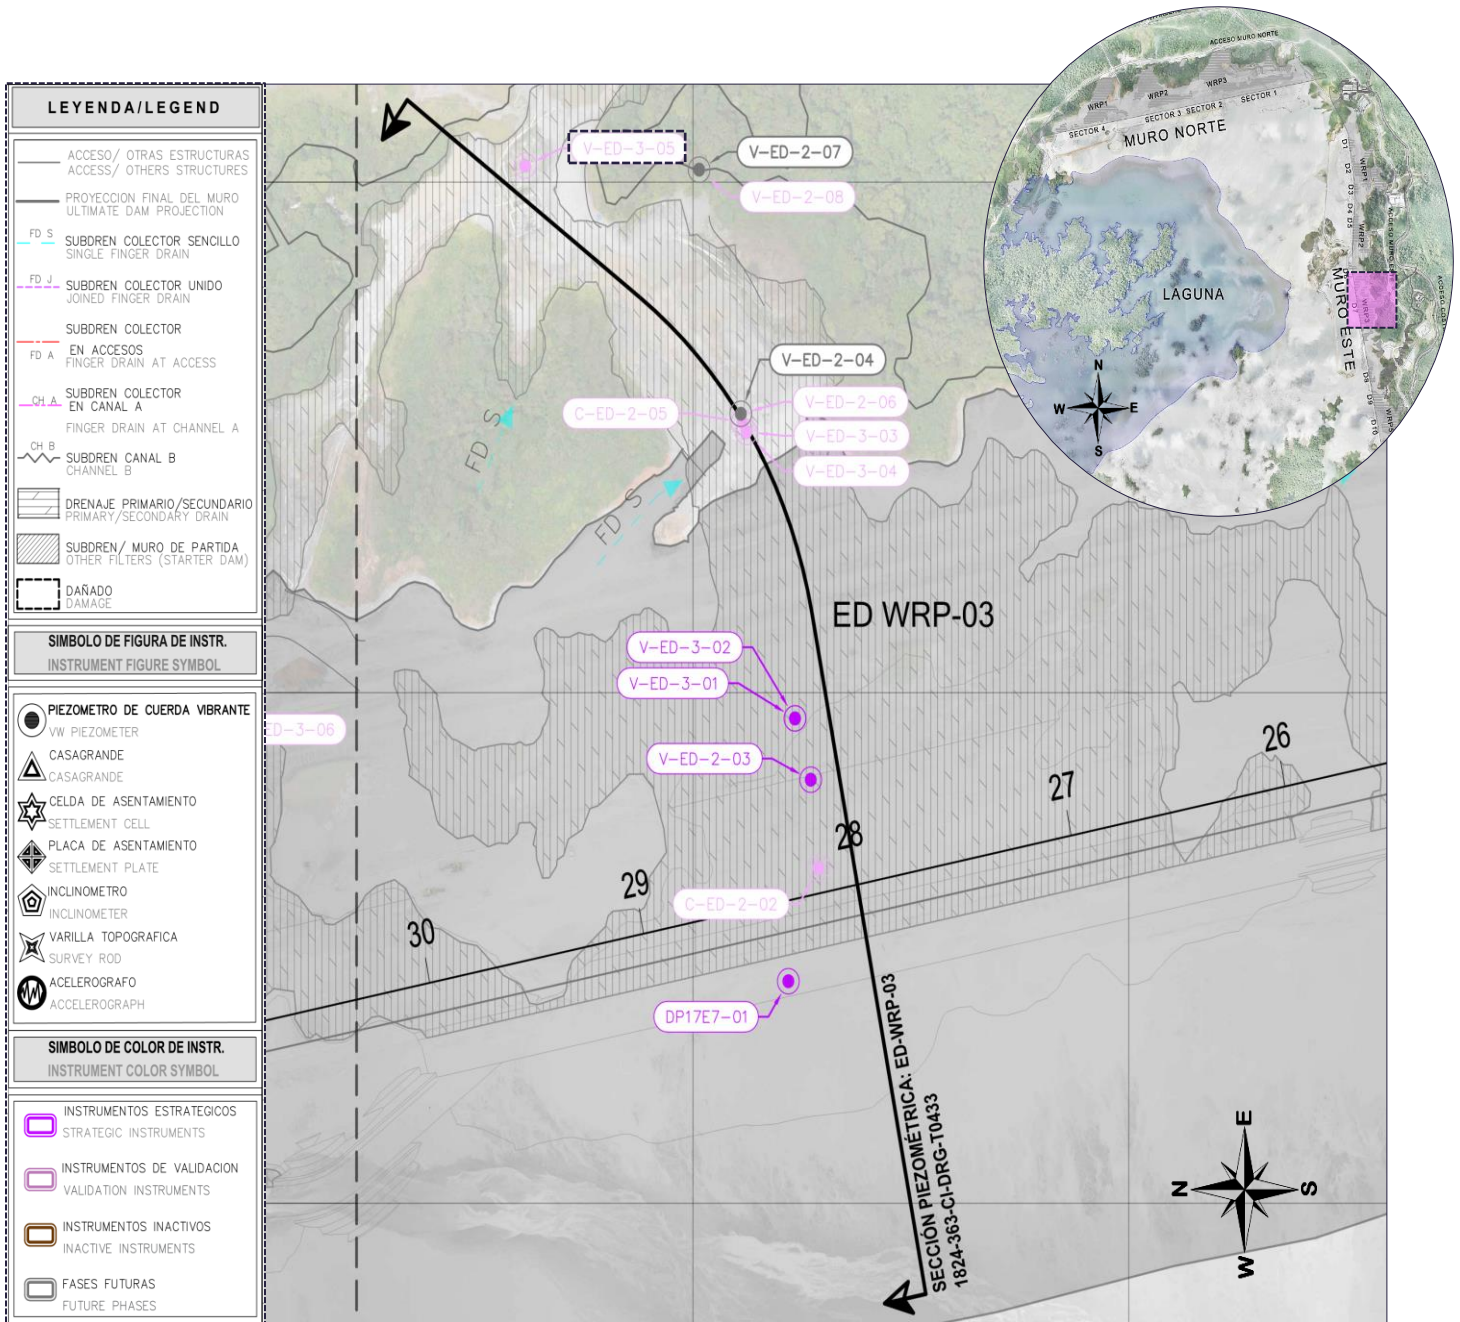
Vista de Planta en el Muro Este WRP3 con Piezómetros
